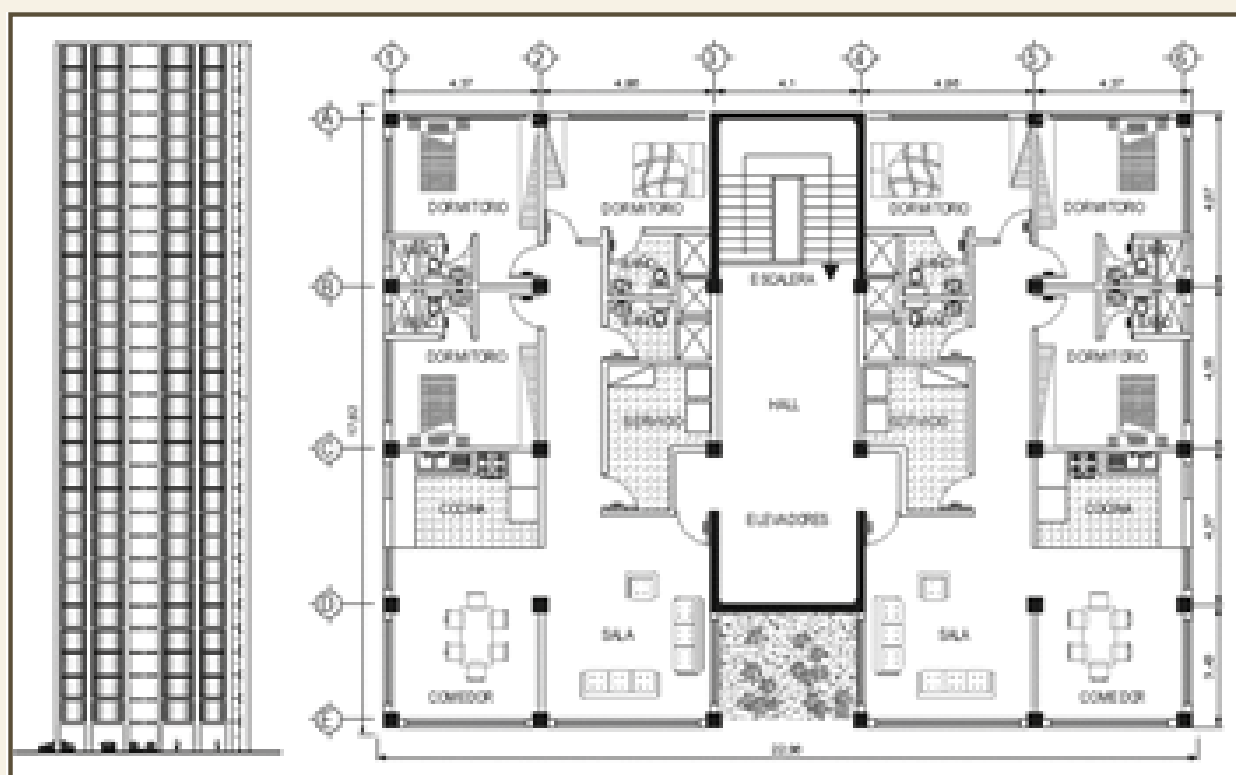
Vista Principal del Edificio y planta Tipo (Fuente: Propia)
